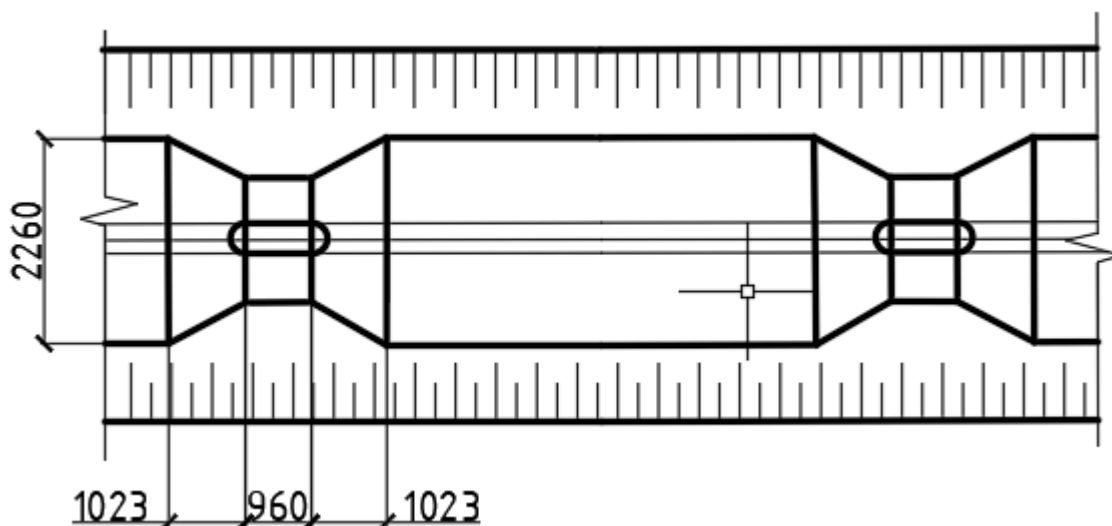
Схема засыпки трубопровода перед испытанием
